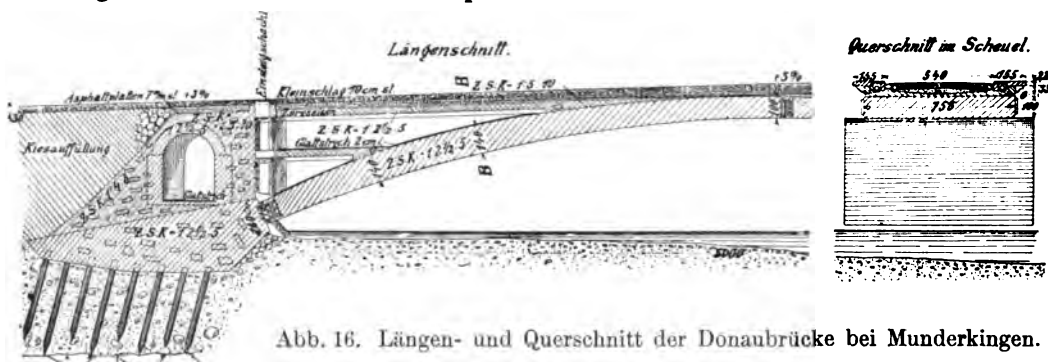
Längen- und Querschnitt der Donaubrücke bei Munderkingen.
